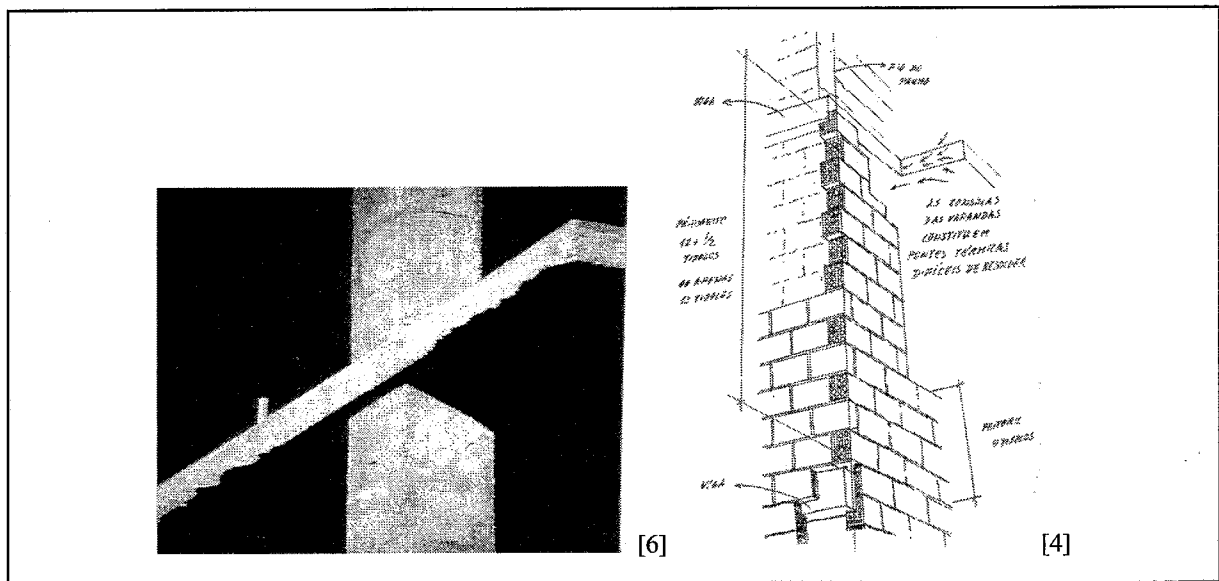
Pormenor do topo de laje saliente para apoio do pano exterior de alvenaria e forra cerâmica nessa zona
